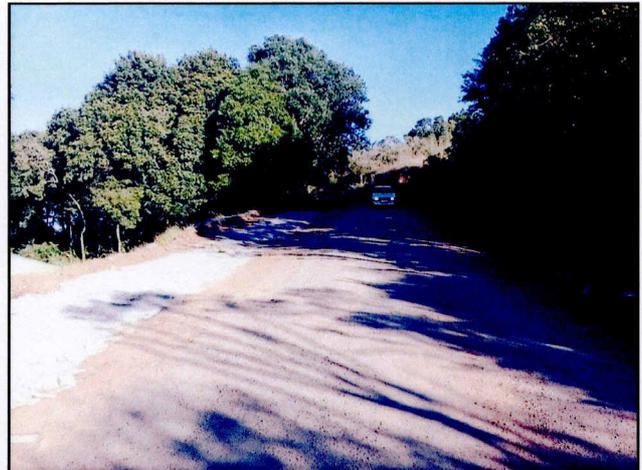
vista norte do leito da Rua existente a ser regularizada, conforme ponto 01 do projeto;
